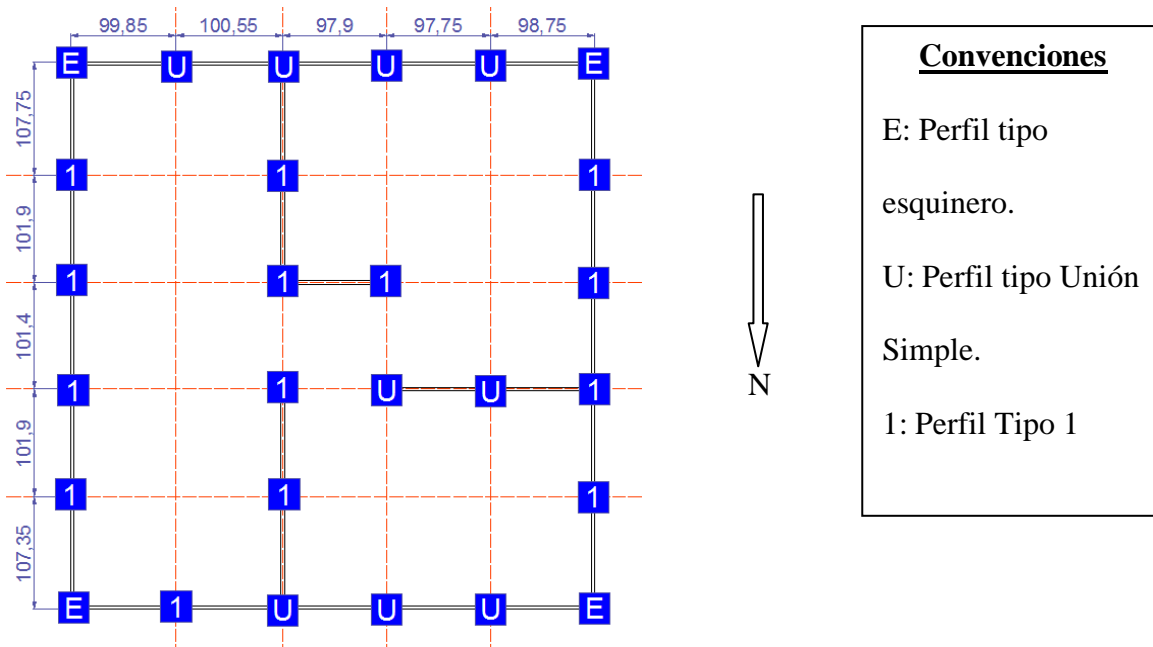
Plano ubicación Perfiles estructurales. Unidades: Centímetros (cm)
